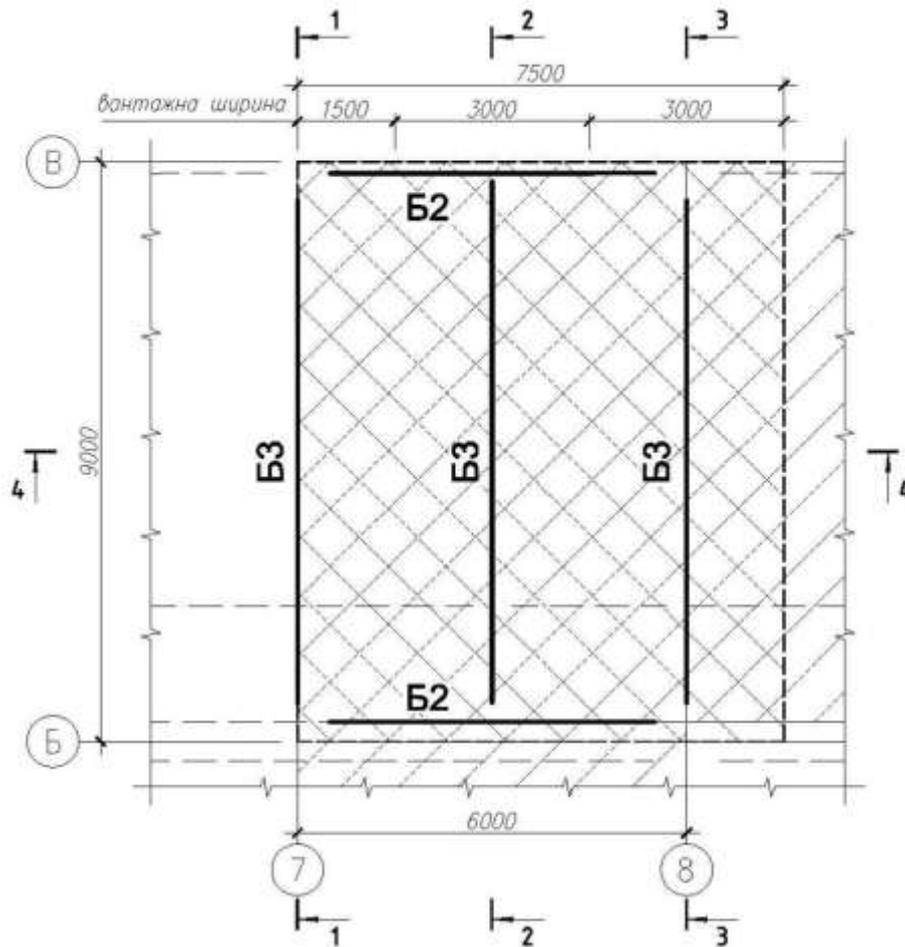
Загальний габарит ділянки випробувань СЗБ перекриття
